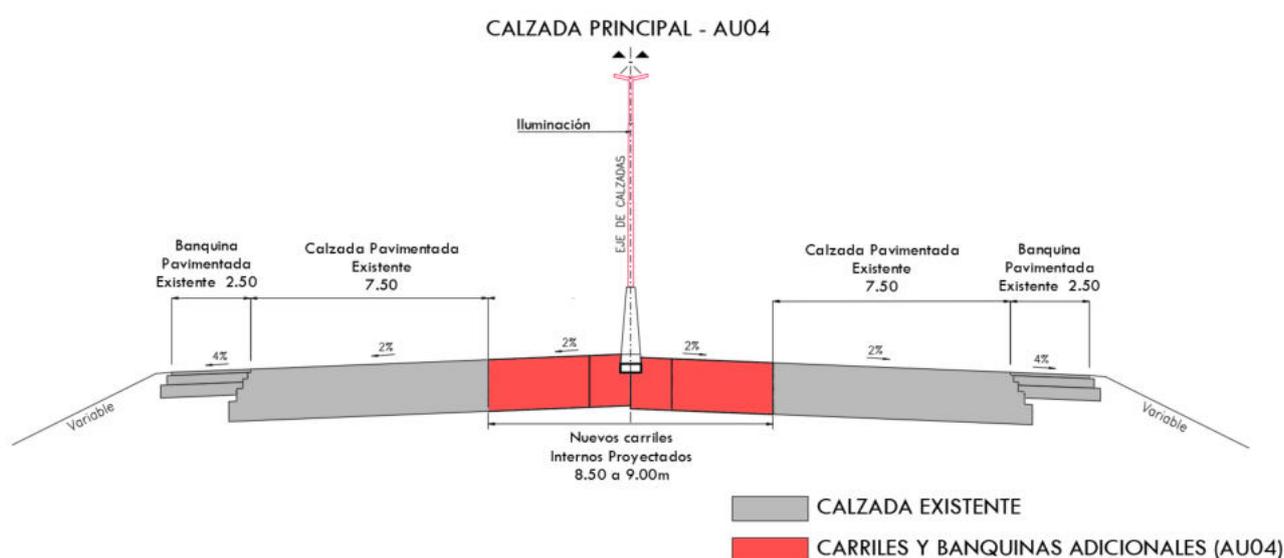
Perfil Transversal de Calzada Principal - Obra AU04
